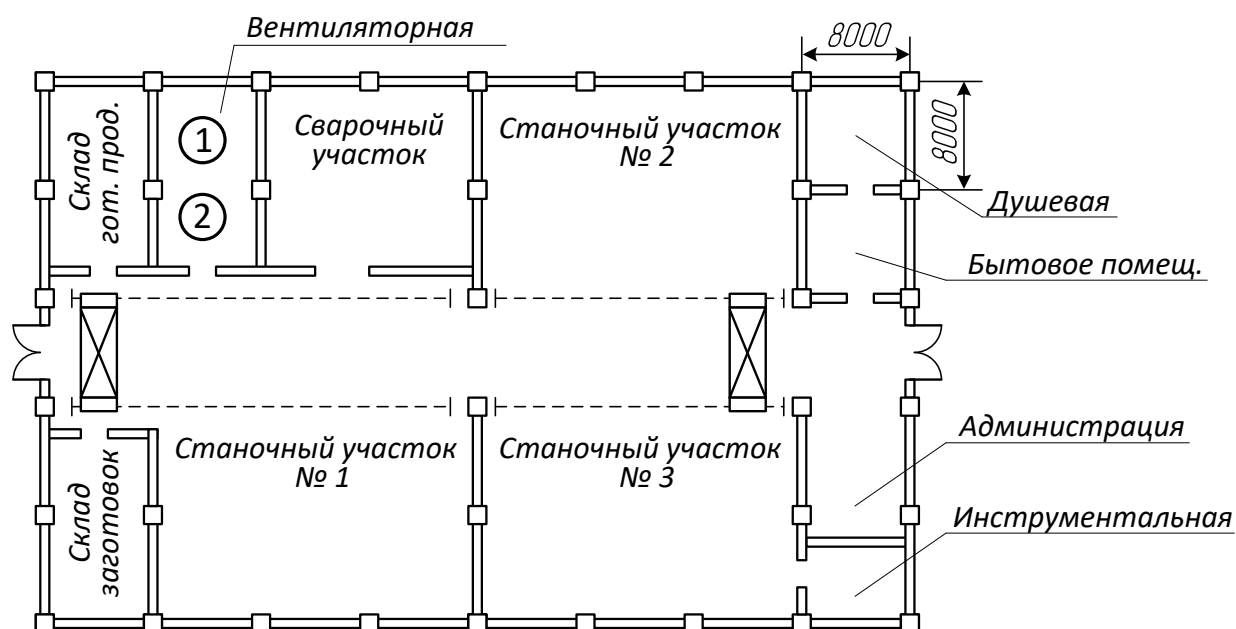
а – Схема ремонтно-механического цеха для вариантов
